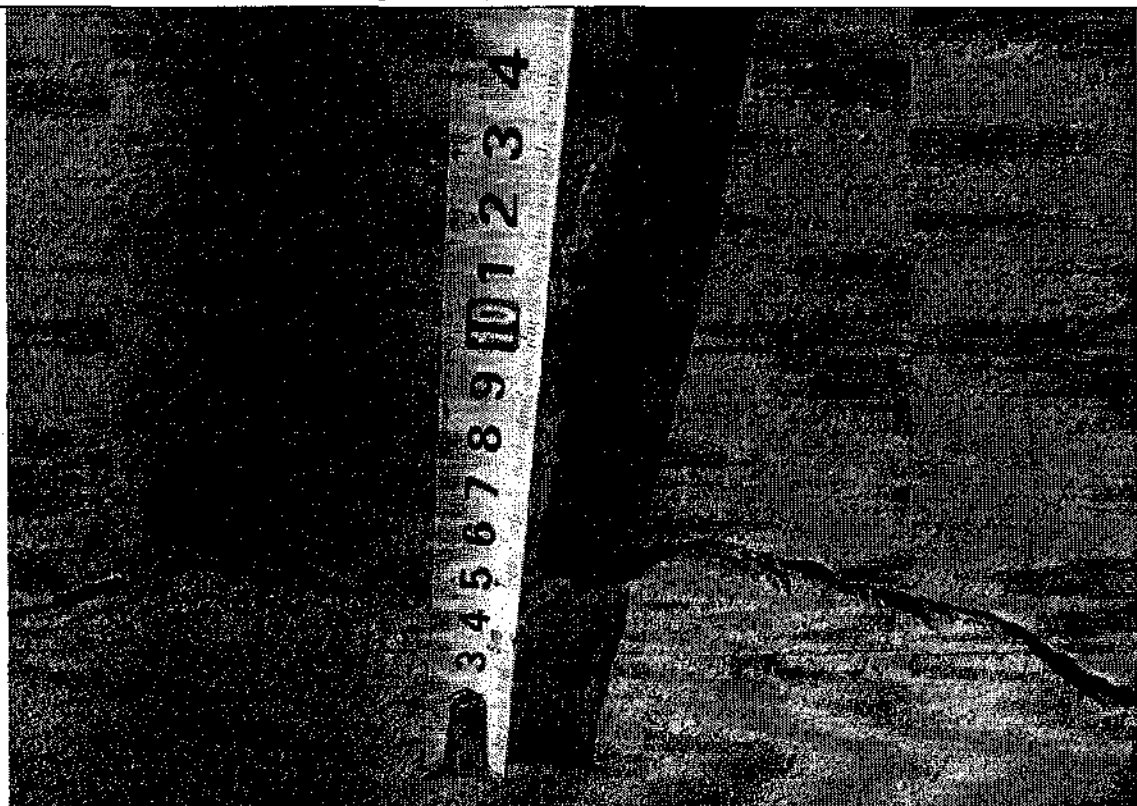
Стены цокольного этажа. Трещины стен цокольной части стен здания шириной раскрытия до 10 мм.
